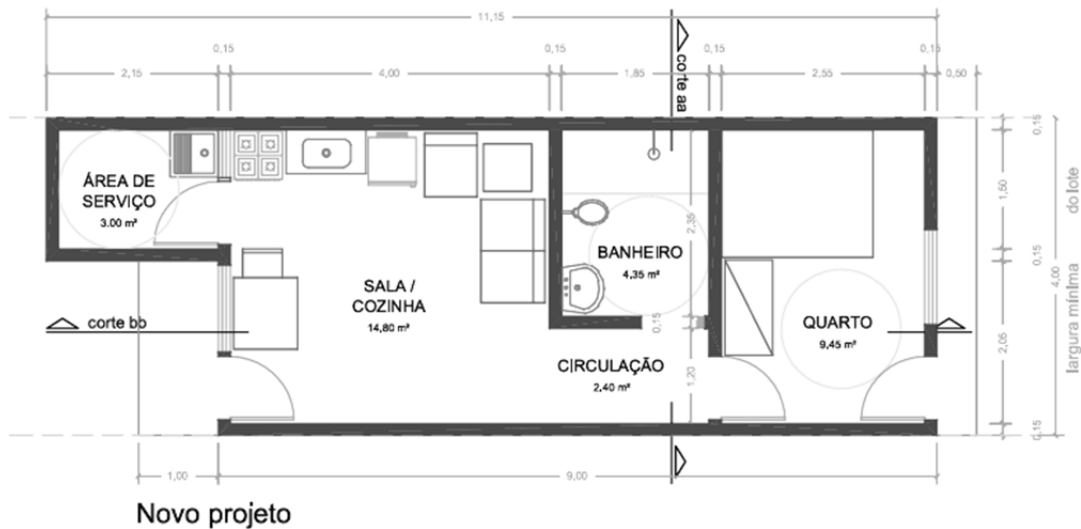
Planta baixa “Novo Projeto A” com indicação da demarcação de projeto modificado.
